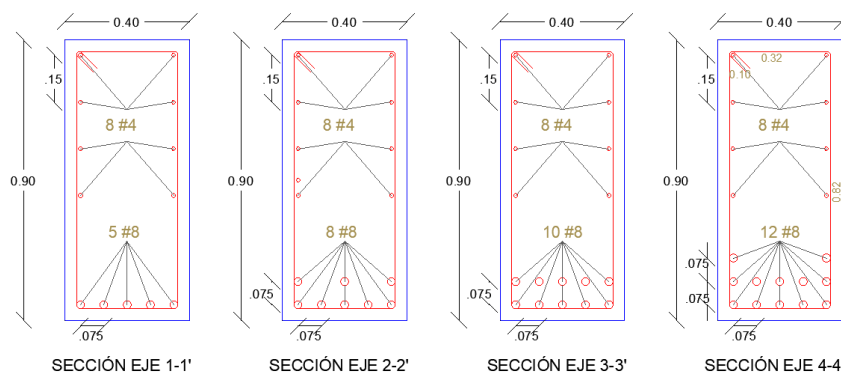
Sección transversal de las vigas para un puente de concreto reforzado de 12 metros. (ver anexo 02 página 02)
